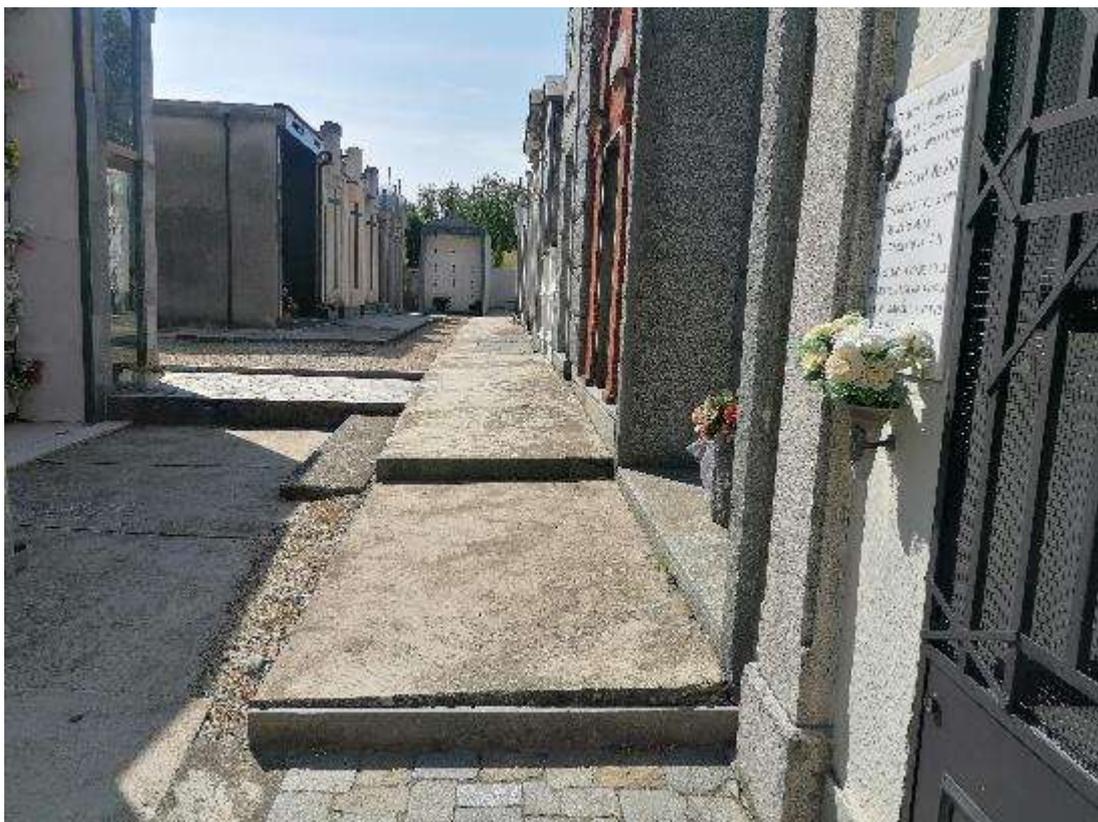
Area comunale dove verrà realizzato la parte di Sub-irrigazione collegata con l'impianto di trattamento dei reflui
